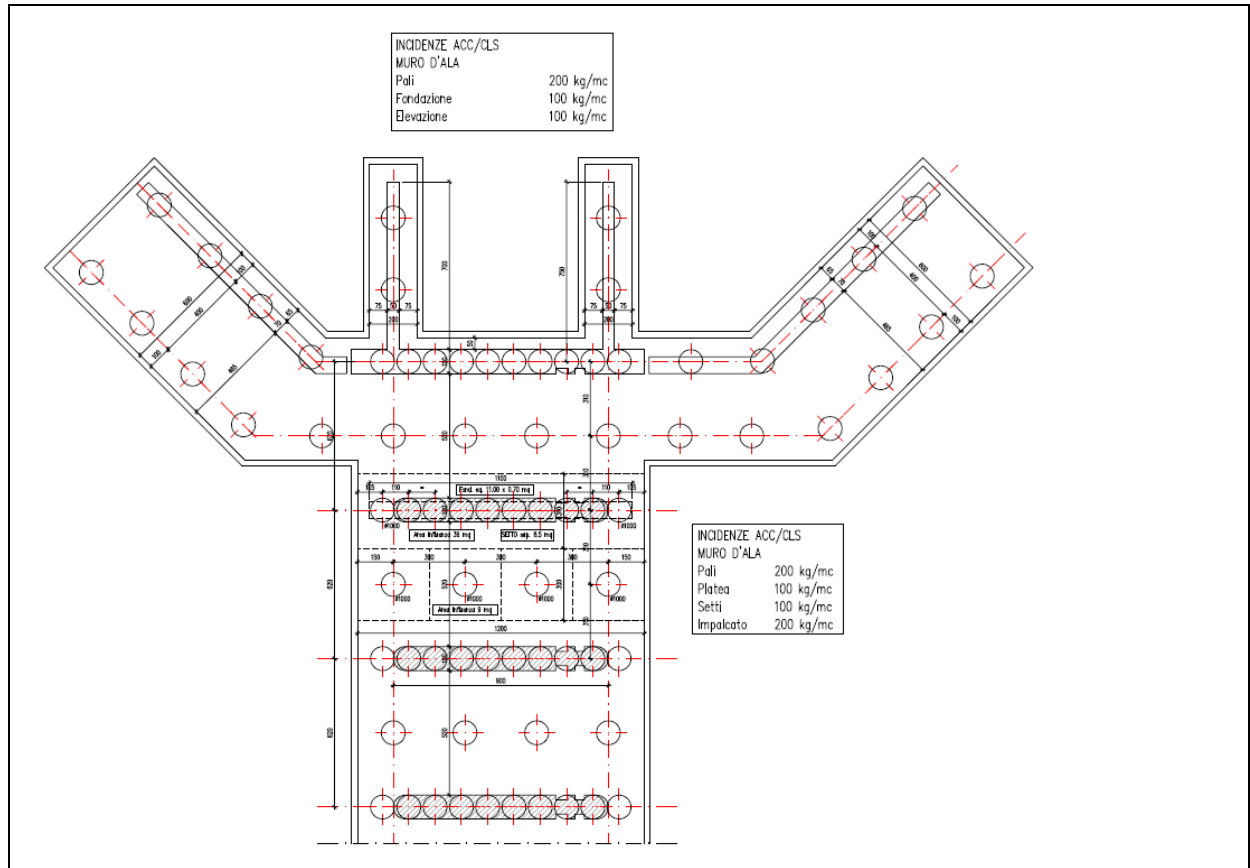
Stralcio planimetrico dell'Opera di Presa e del Muro d'Ala
